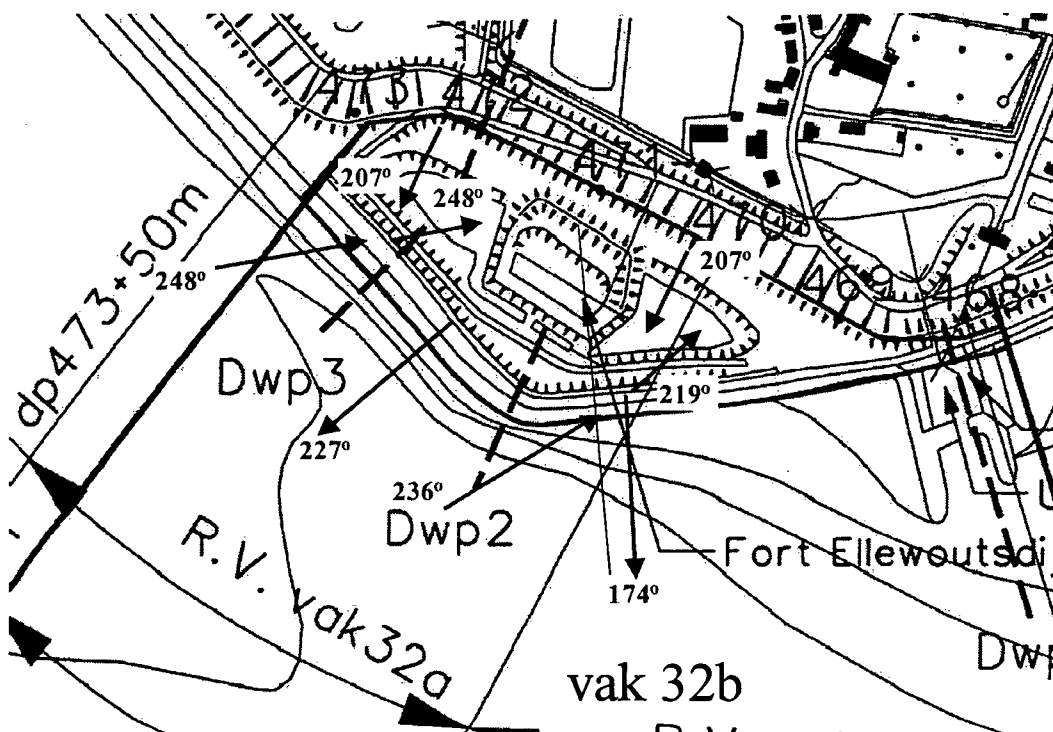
Luchtfoto Fort Ellewoutsdijk met te berekenen dijkvakken
